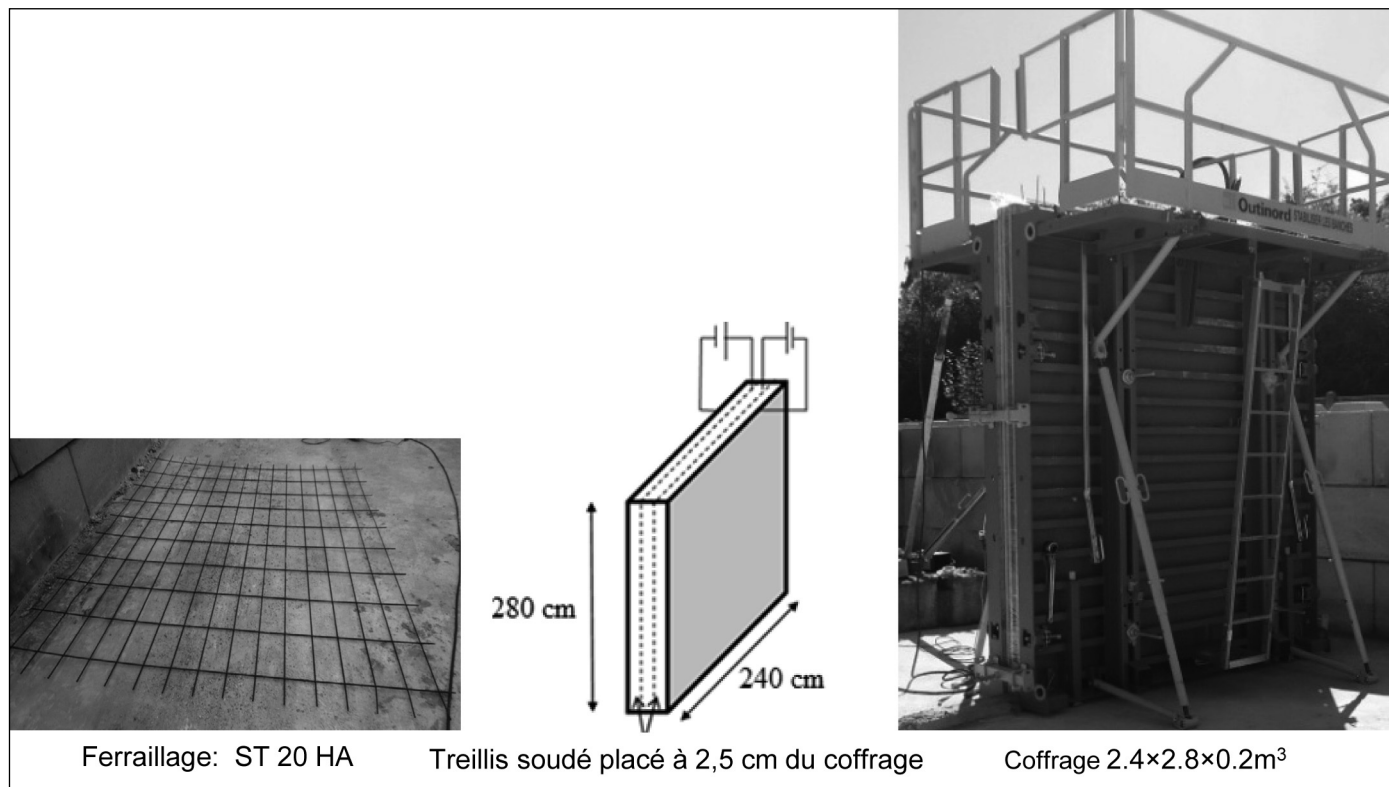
Essai in-situ- coffrage et mise en place du ferrailage
